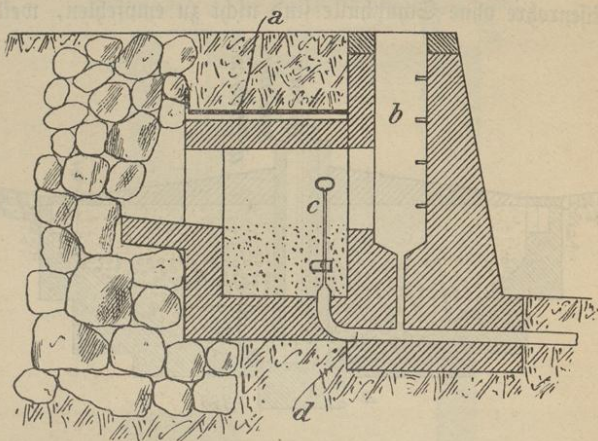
a Abdichtung, b Einsteigschacht, c Brunnenstich, d Abzugsrohr.
